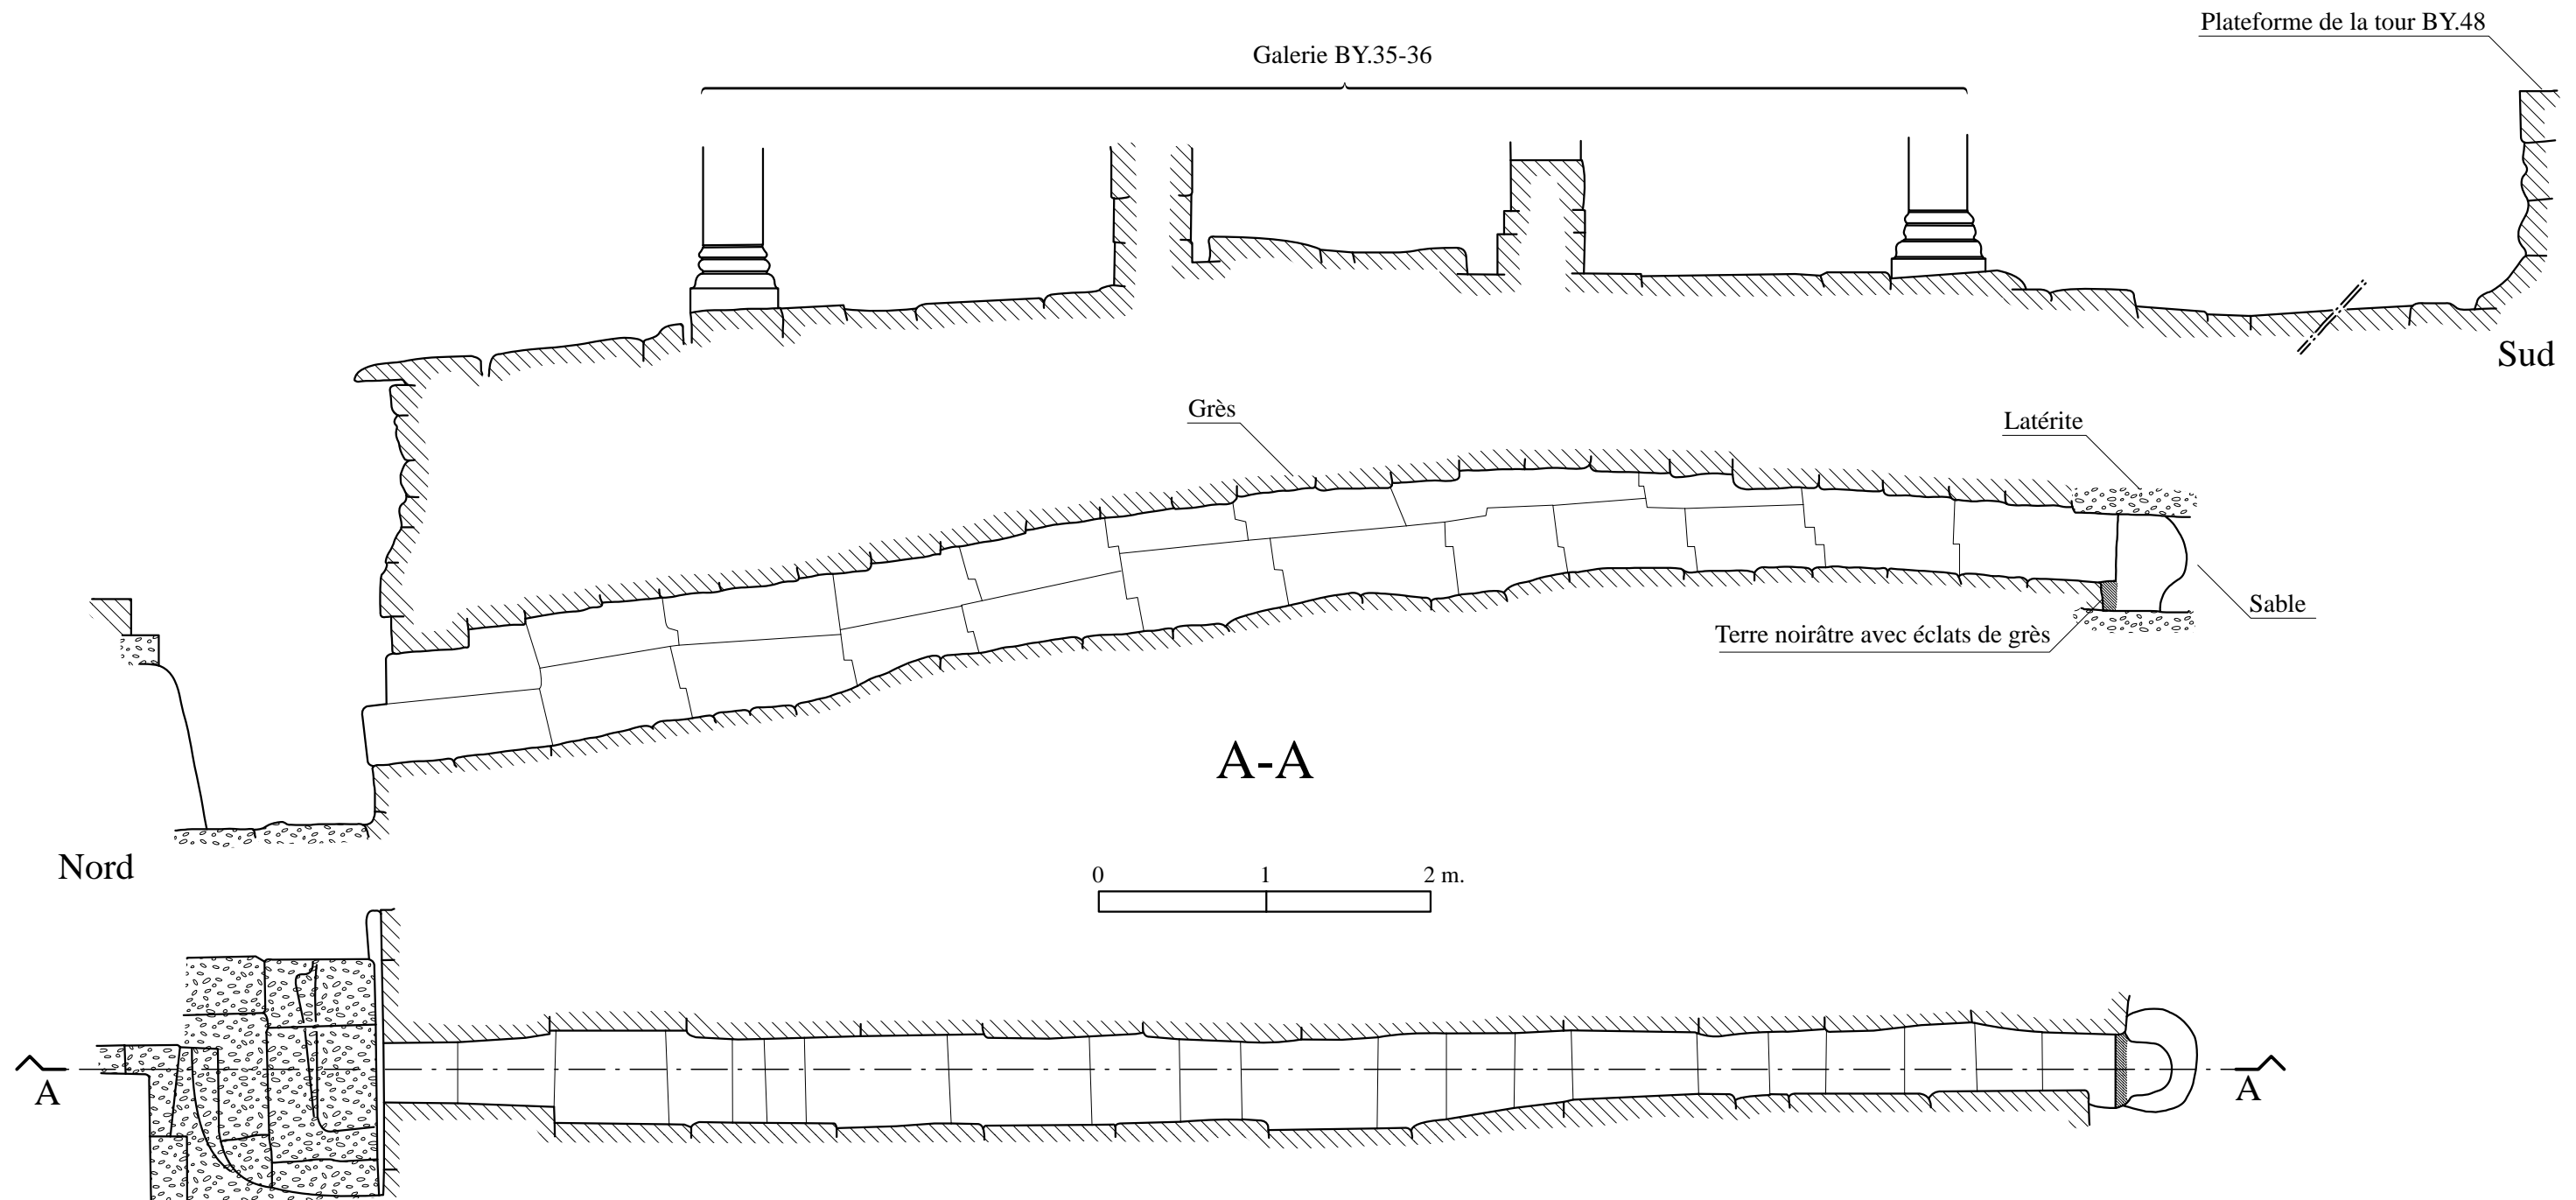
Plan et coupe du système de drainage enfoui dans le soubassement de la galerie BY.35-36 (d'après JSA)
